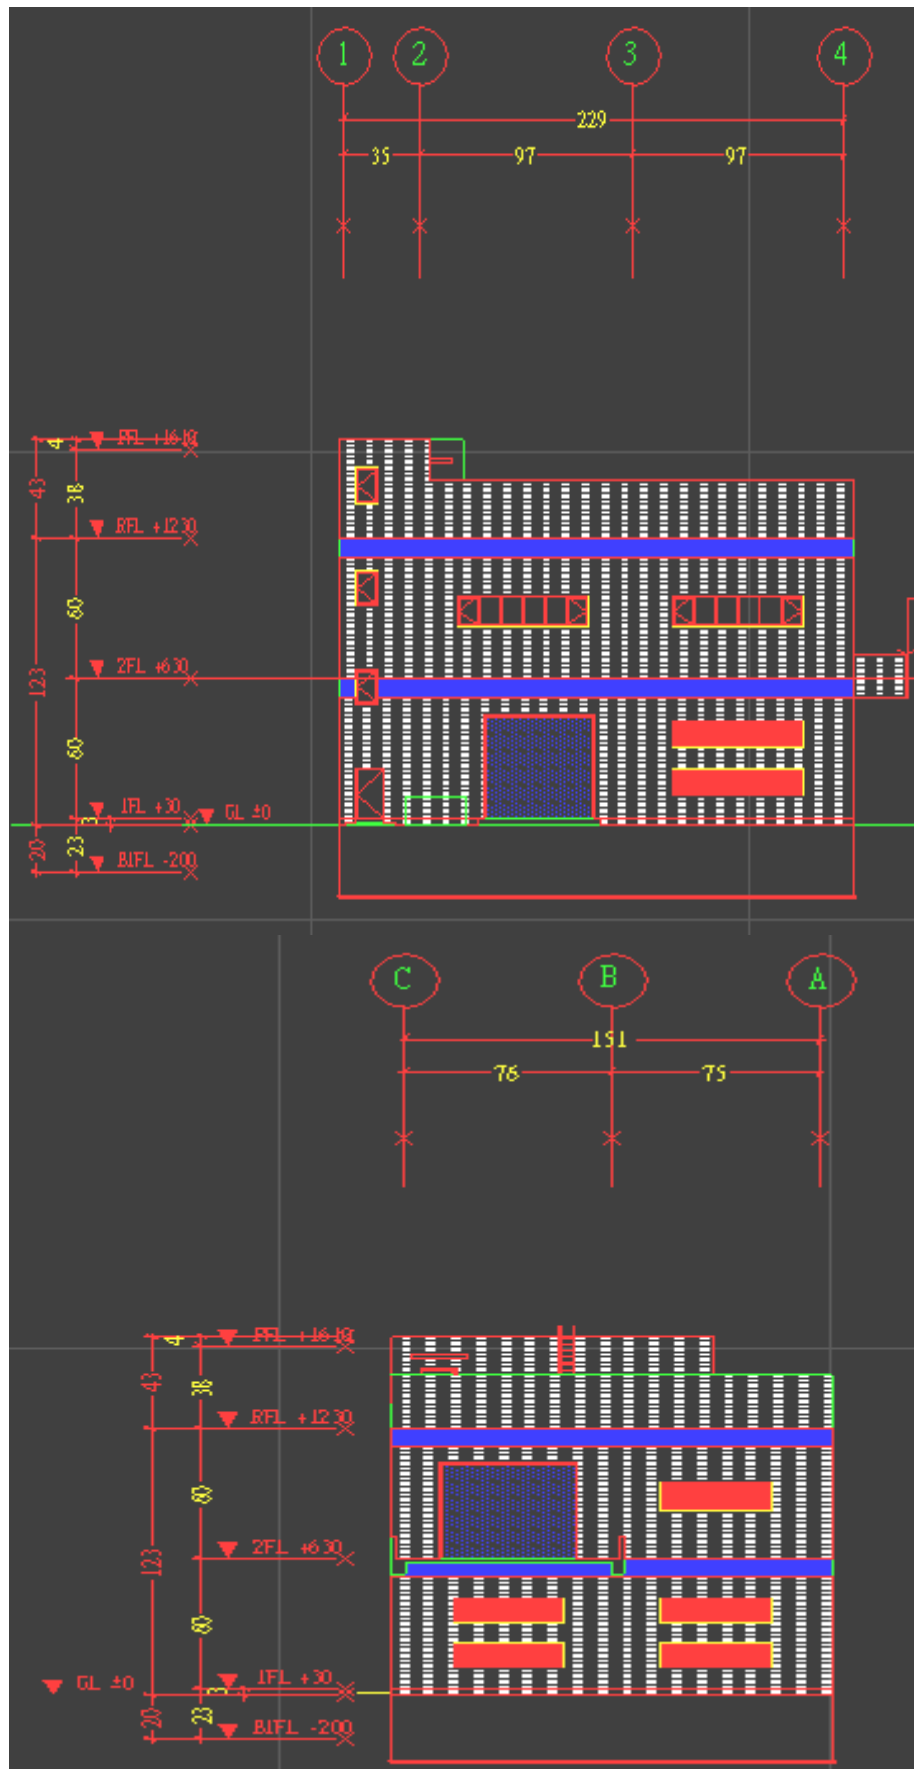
AutoCAD 繪製 傳統 2D 立面圖示
